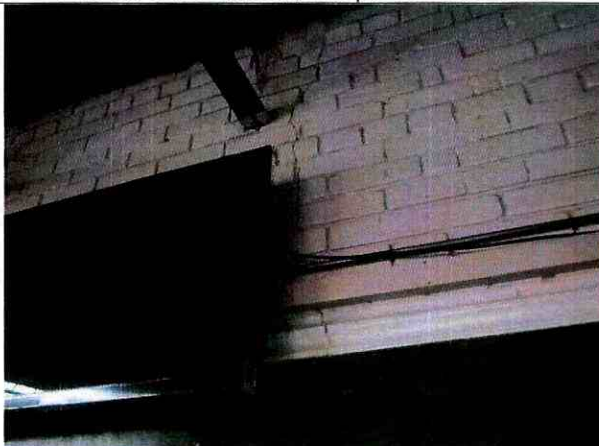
Detalle de la fisura vertical en muro divisorio.
